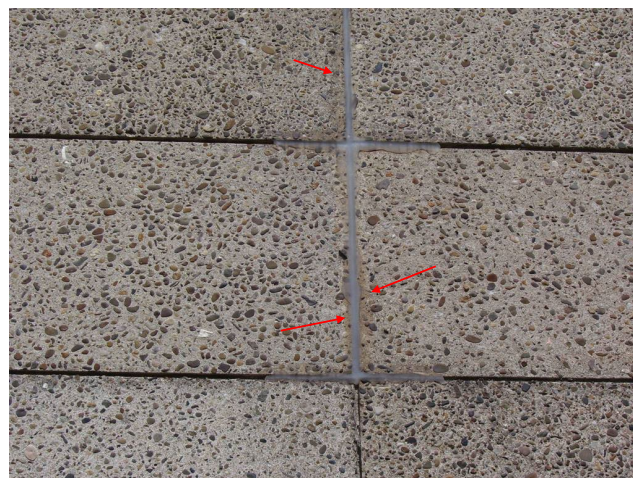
Voorbeeld verkleuren beton door uittreden siliconenolie uit kitvoeg.
